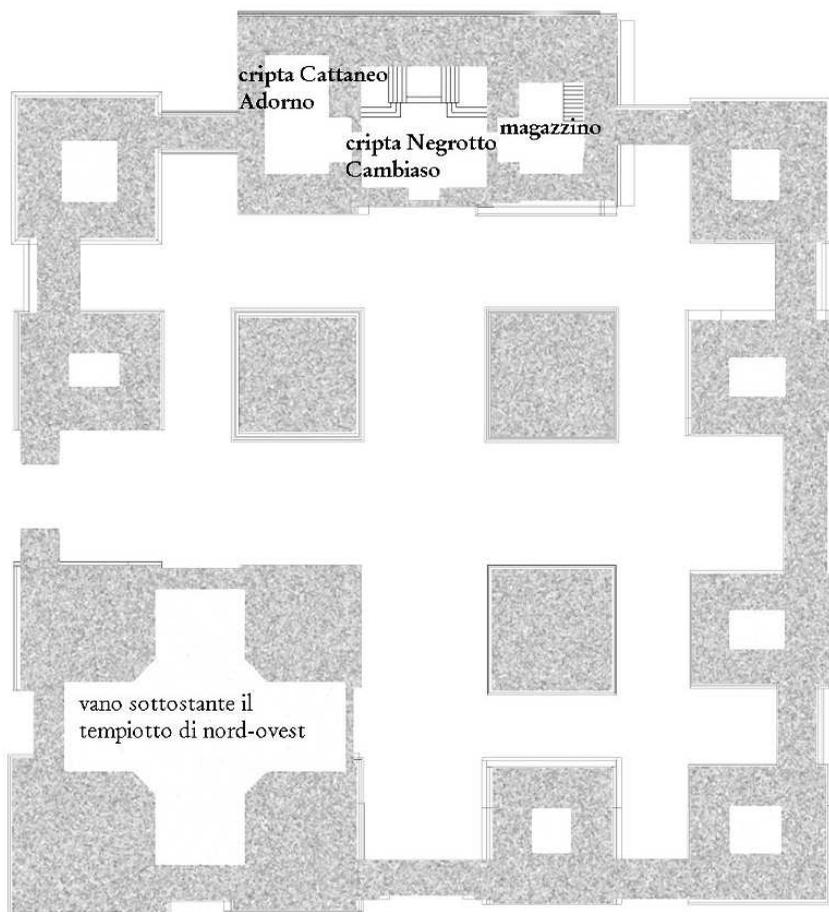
Pianta delle stanze sotterranee e delle fondazioni.
